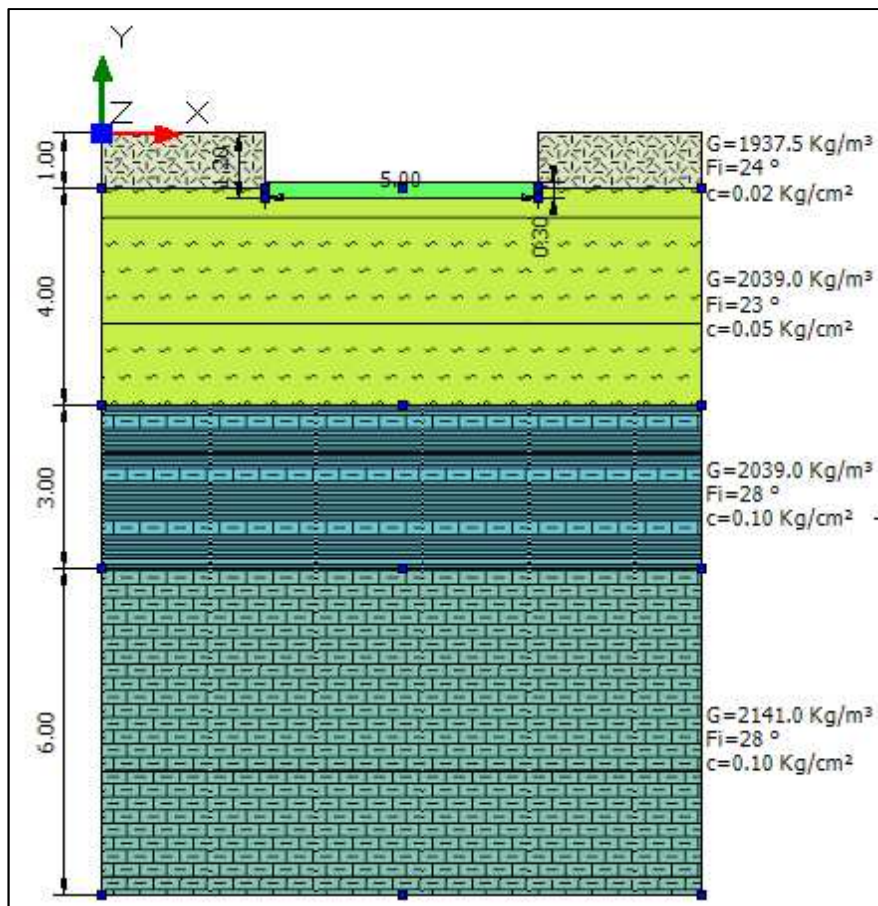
Modello stratigrafico con ipotesi di fondazione a platea.
